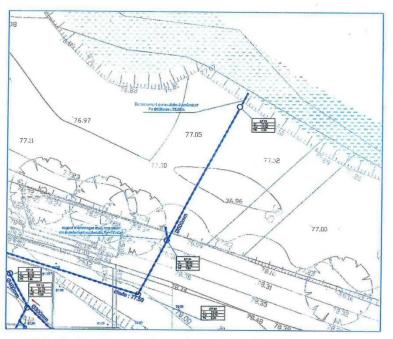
Extrait du plan des réseaux projetés de la déchèterie de la Charoussière
